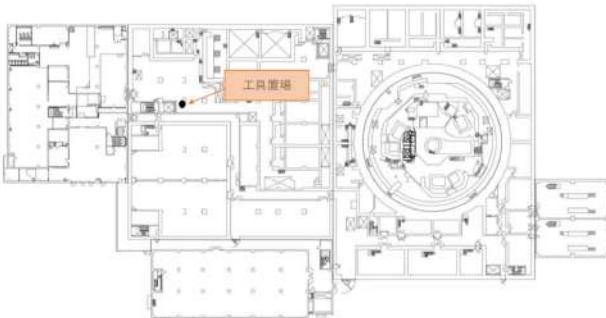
原子炉辅助建屋 1階工具類配置図
